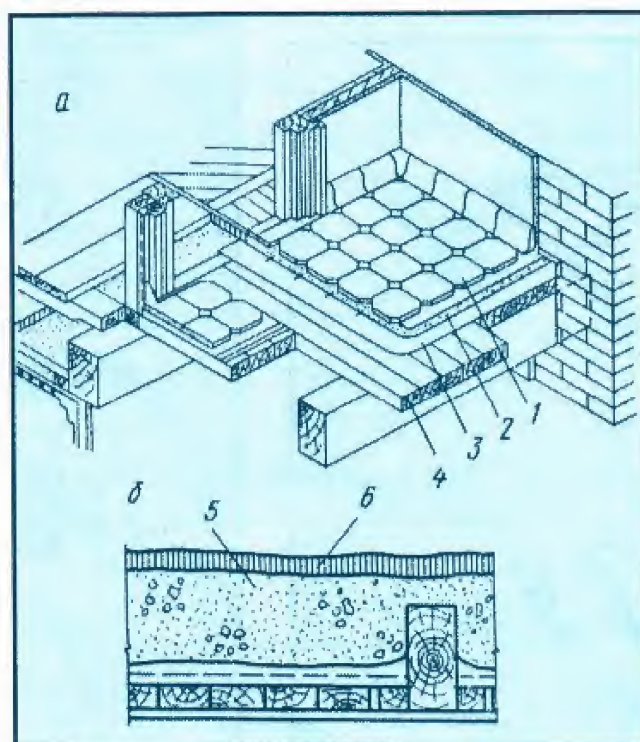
Дерев'яні перекриття: а - санітарного вузла; б - горищне; 1 - керамічна плитка; 2 - цементна стяжка; 3 - гідроізоляція; 4 - настил із шунтованих брусків; 5 - теплоізоляція; 6 - корка.
